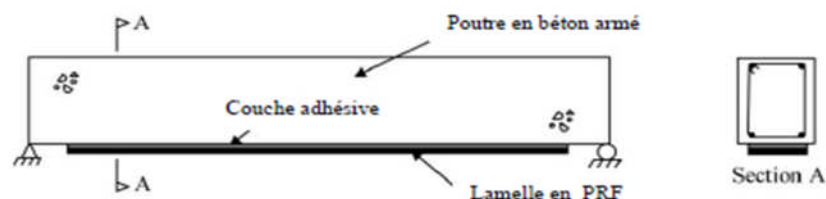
Une poutre en béton armé renforcée par une lamelle en PRF [25].
